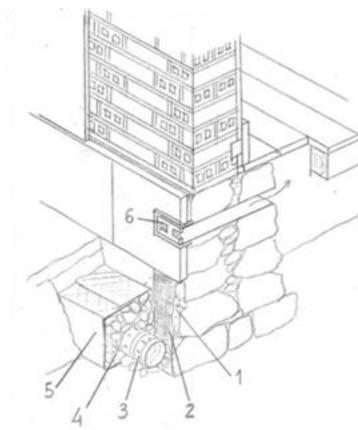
5 - Corte em perspectiva da drenagem junto a fundação. 1-Regularização da face da fundação, 2-Pintura betuminosa, 3-Geodreno, 4-Seixo rolado, 5-Geotêxtil, 6-Grelha de ventilação [10].
